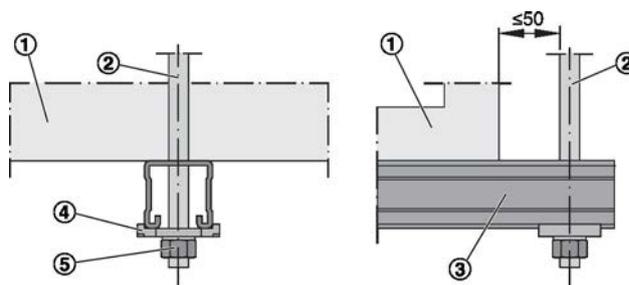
Montage suspendu du volet de désenfumage (sur site)
